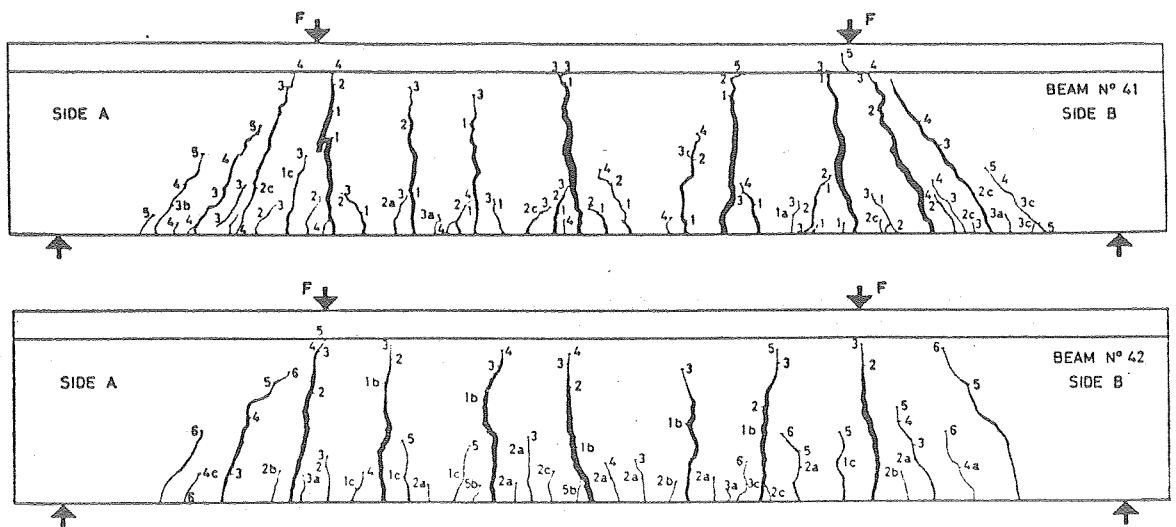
Quadros de Fissuração das Vigas 41 e 42 às Escalas 1:1 e 1:2,5 respectivamente (FERRY BORGES e ARGÁ E LIMA, 1961)
